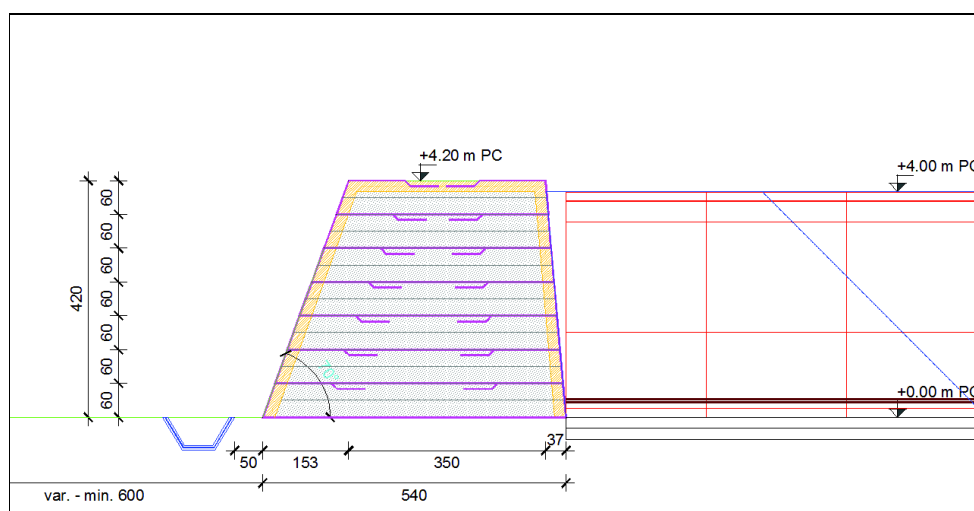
Sezione tipo dello stato di progetto rappresentativa del rilevato perimetrale, delle vasche in cls e della canaletta di scarico prefabbricata.
